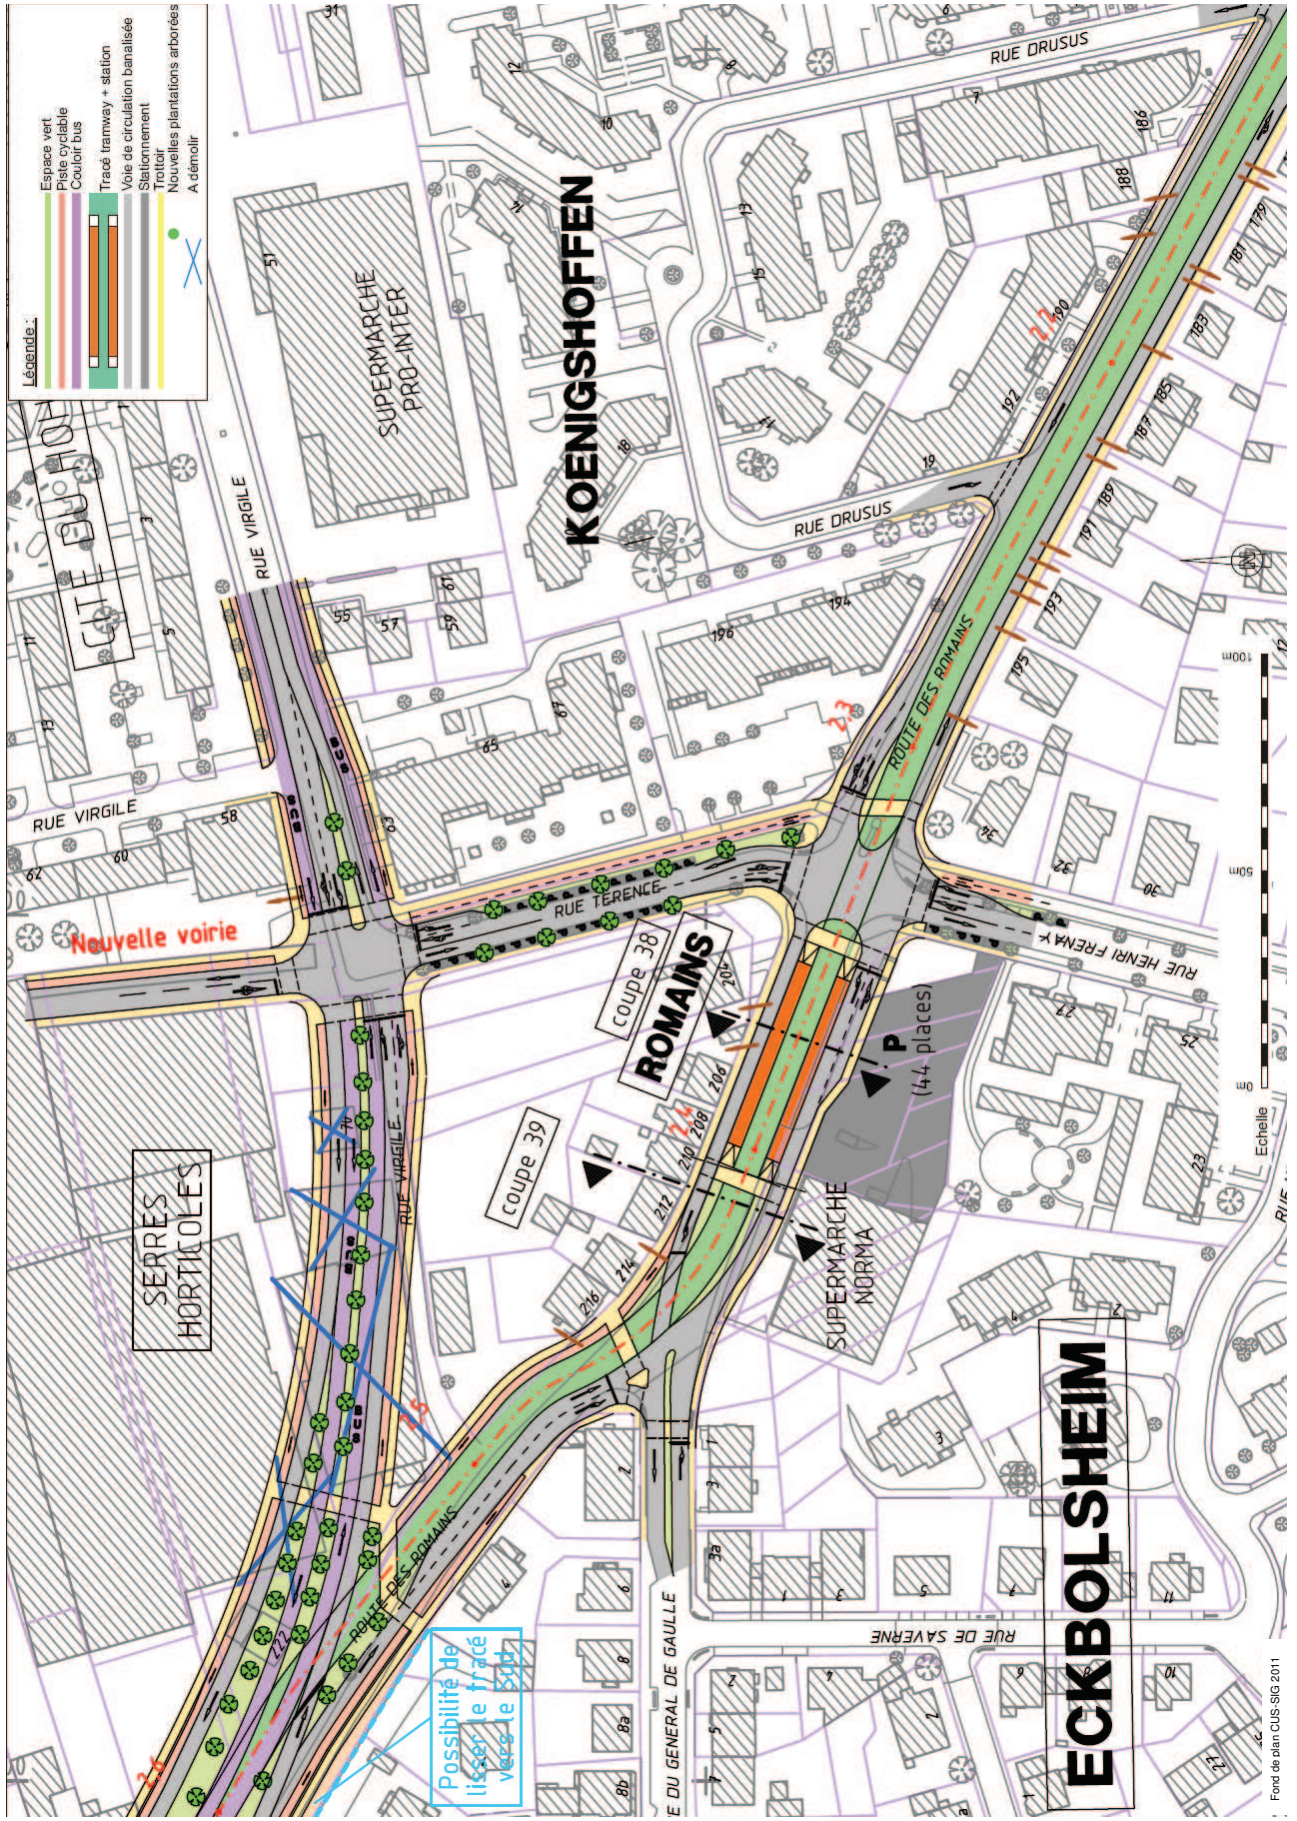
Plan zoom sur secteur "Monseigneur Raess / Virgile"
